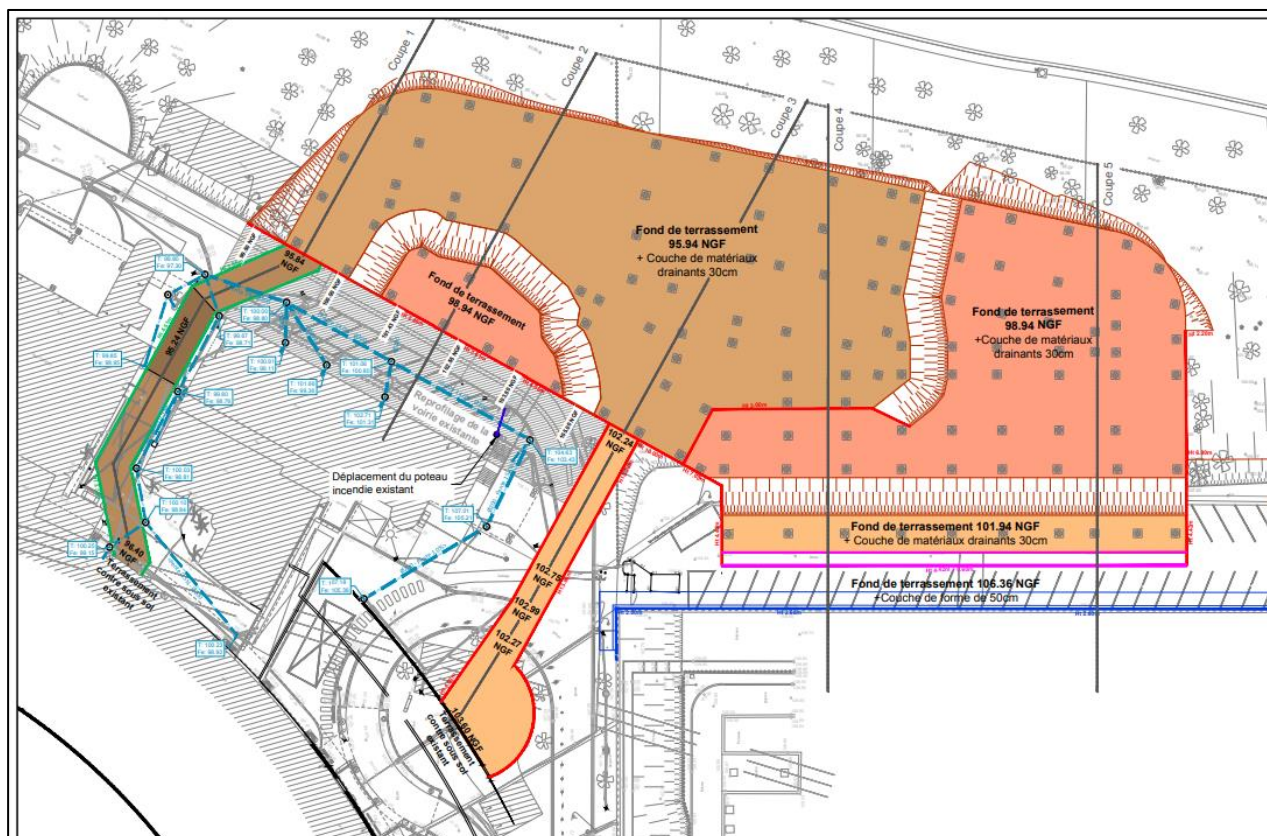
Plan des cotes de terrassement du futur projet (Source : AP-HP- Janvier 2025)
